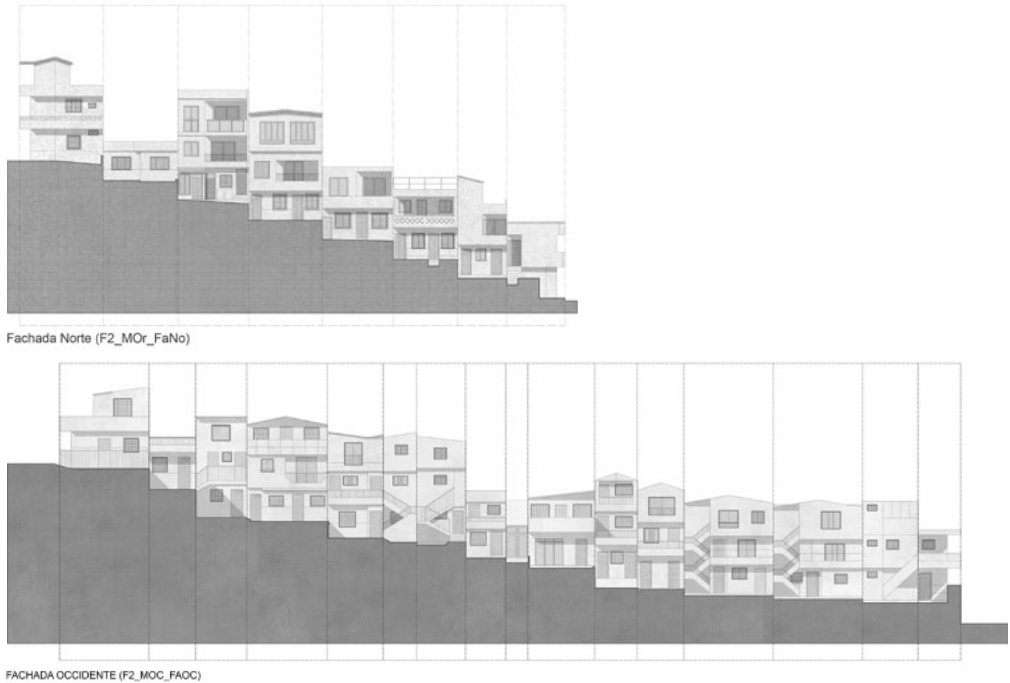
Fachadas Fachadas norte y occidente de la manzana F2-Mor.
